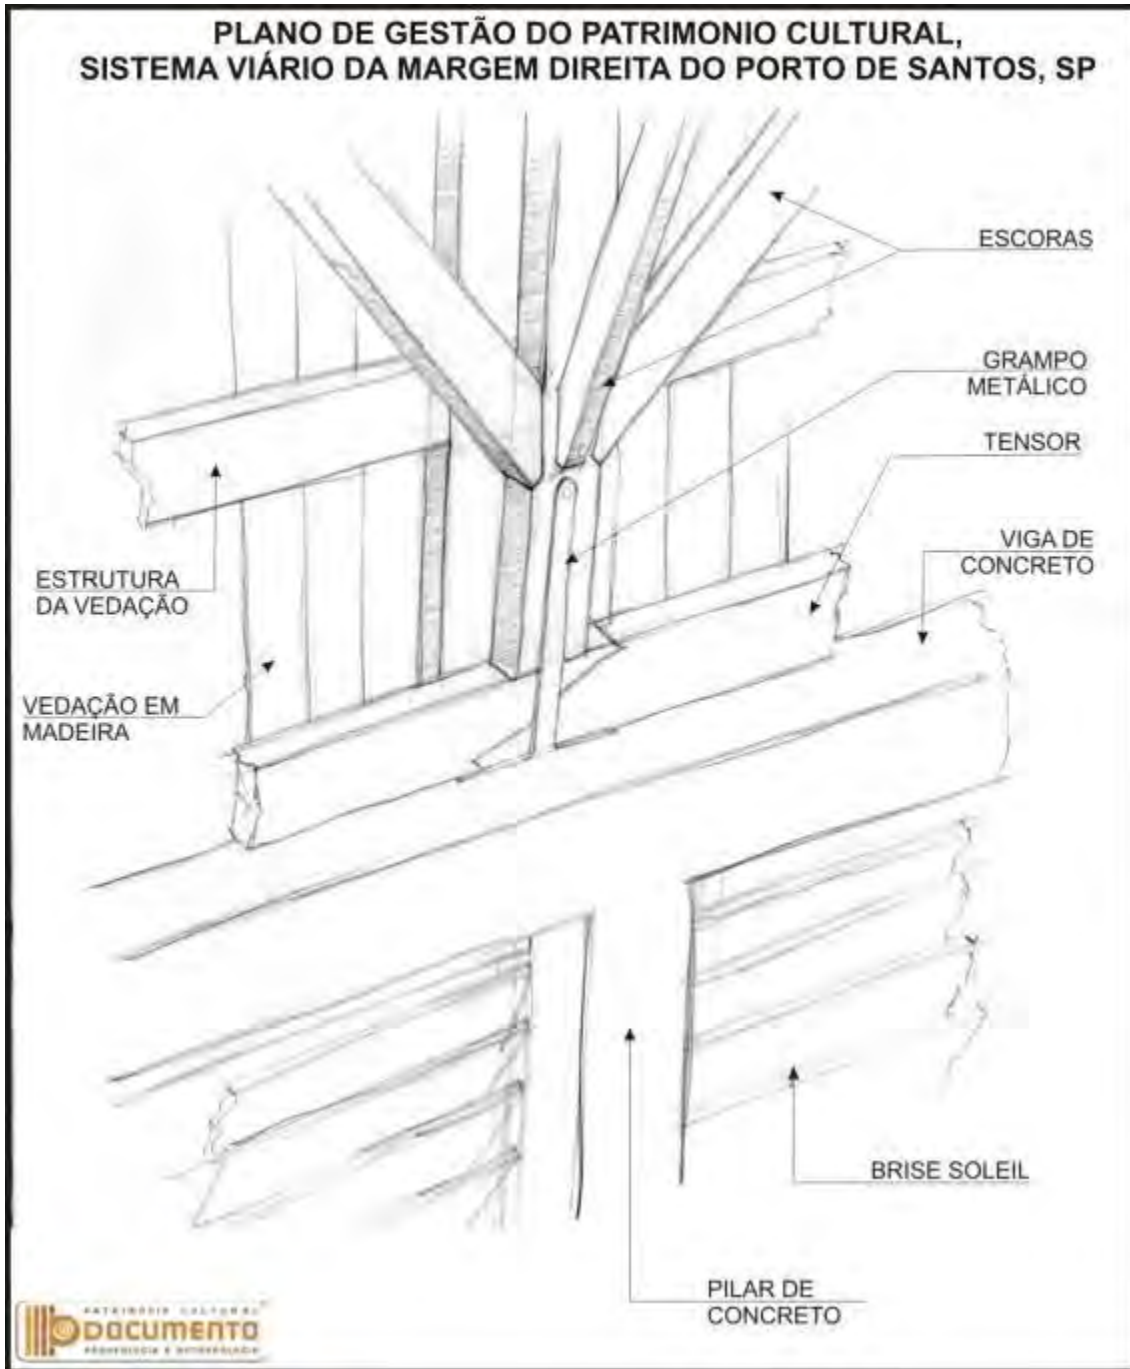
Croqui de detalhamento do madeiramento de sustentação do telhado
